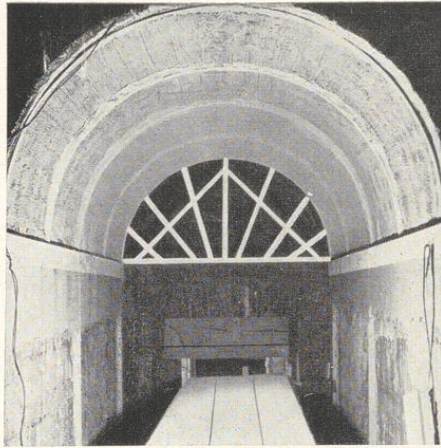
Tonnengewölbe, nach Pariserleisten teilweise fertig grundiert. Die Gipslehren werden mit dem Lehrbogen auf dem ausgedrückten Grund angelegt
